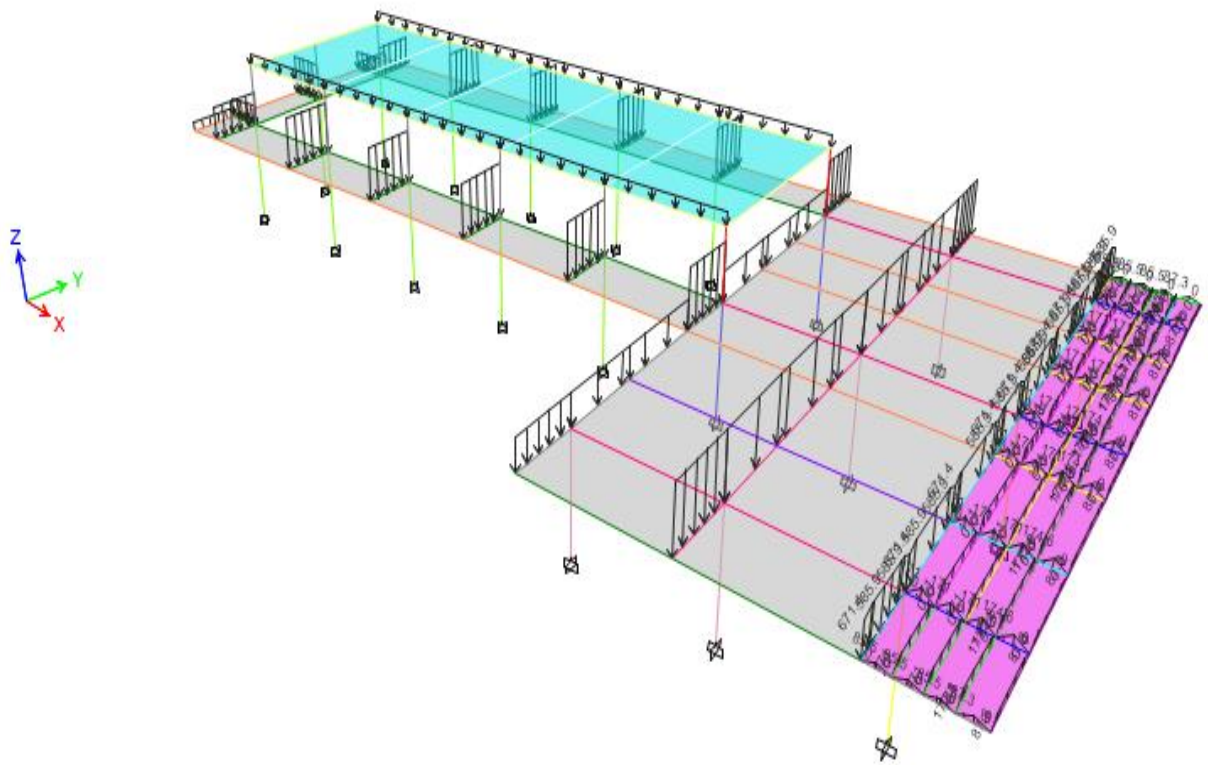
Cargas vivas sobre estructura restaurante. (KN/m)
